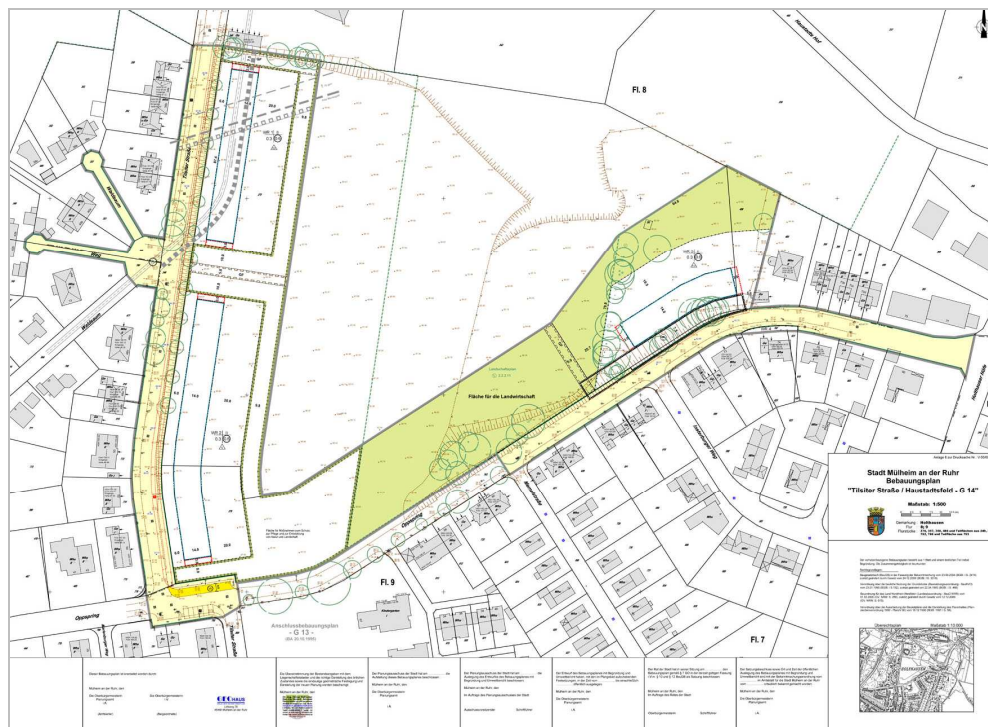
Bebauungsplan G 14 "Tilsiter Straße / Haustadtsfeld"
